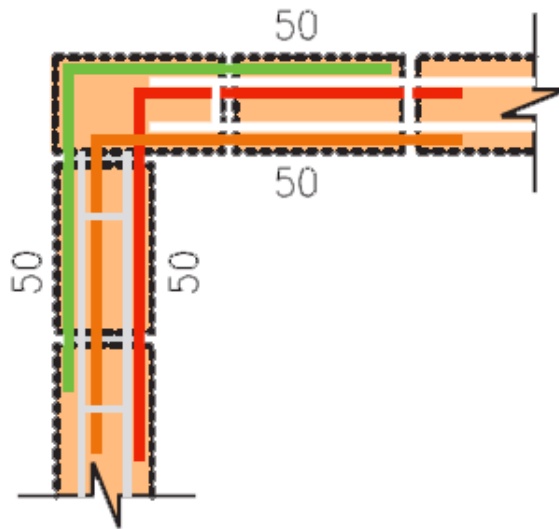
Detalle del supe en los extremos de las barras de refuerzo horizontal. Encuentro de muros en L (ACMA, 2011)
